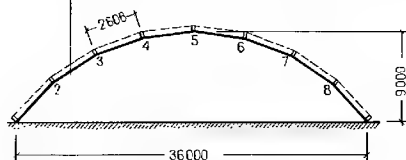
Поперечный разрез кровельного перекрытия с сводом (пример)
